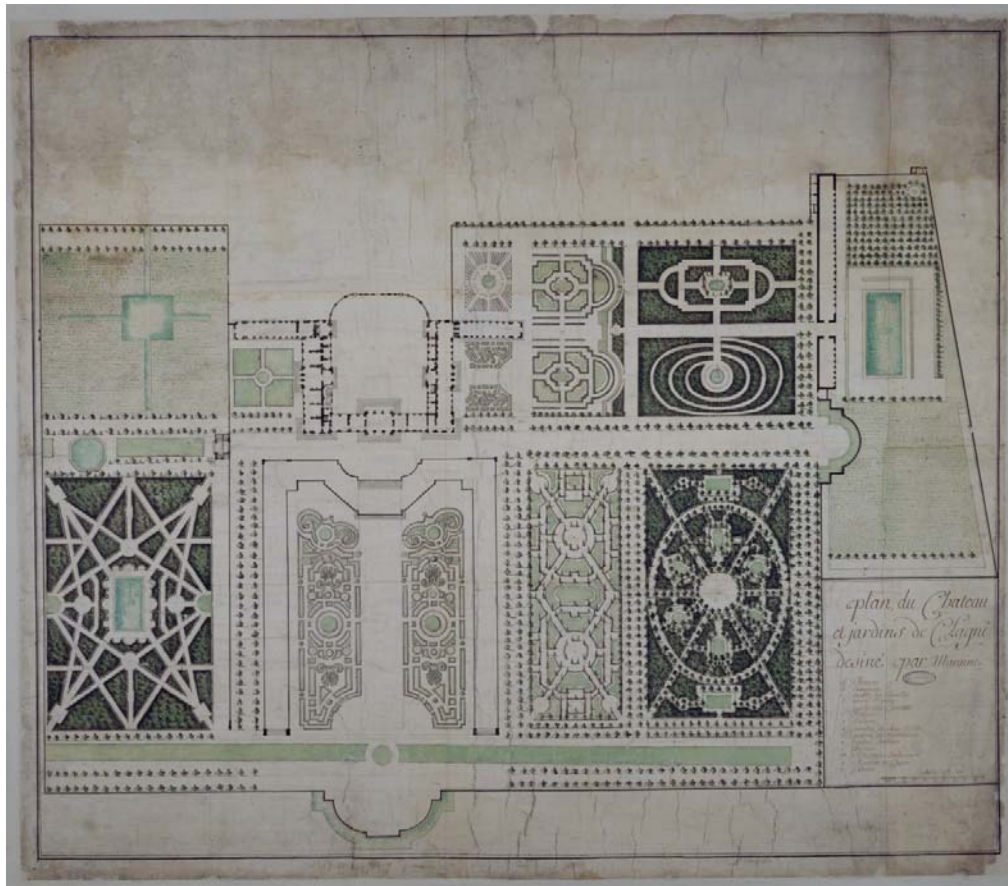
Barockgarten Plan – Plan du Château et des jardins de Clagny
